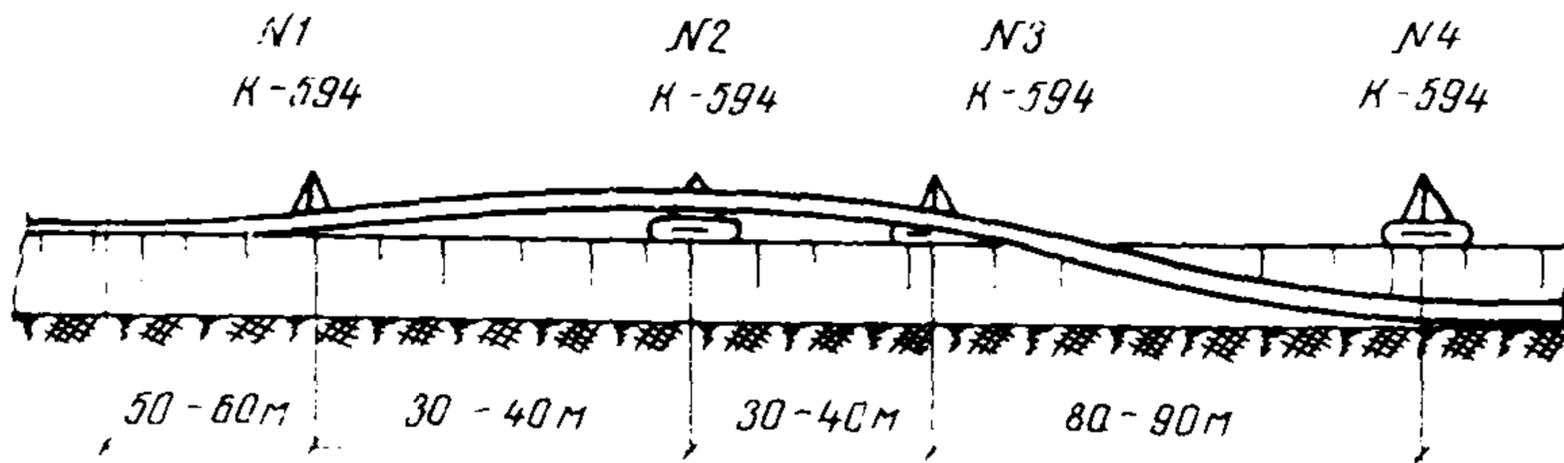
Размещение механизмов в колонне при укладке изолированного трубопровода
